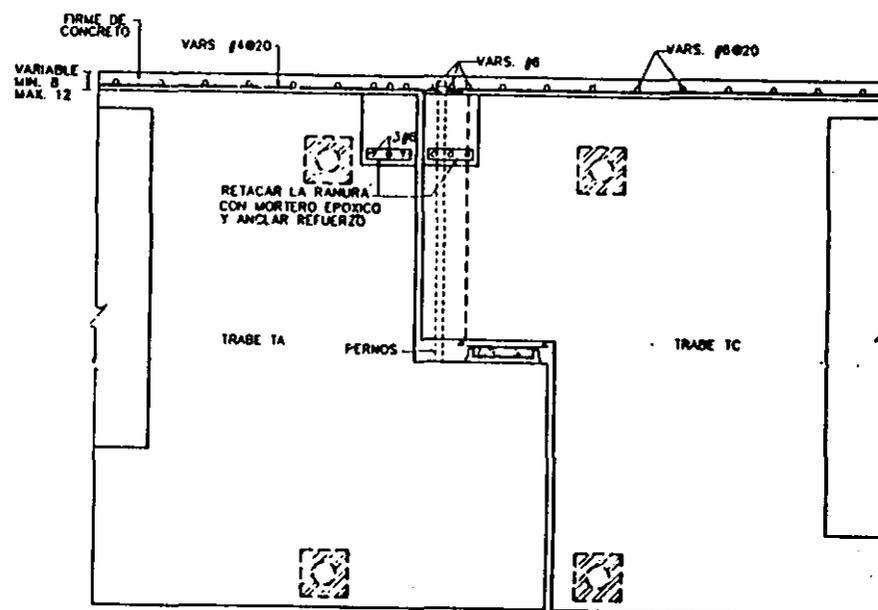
A(2). Unión Entre Trabe de Apoyo y Trabe de Cierre (vista de Costado).
